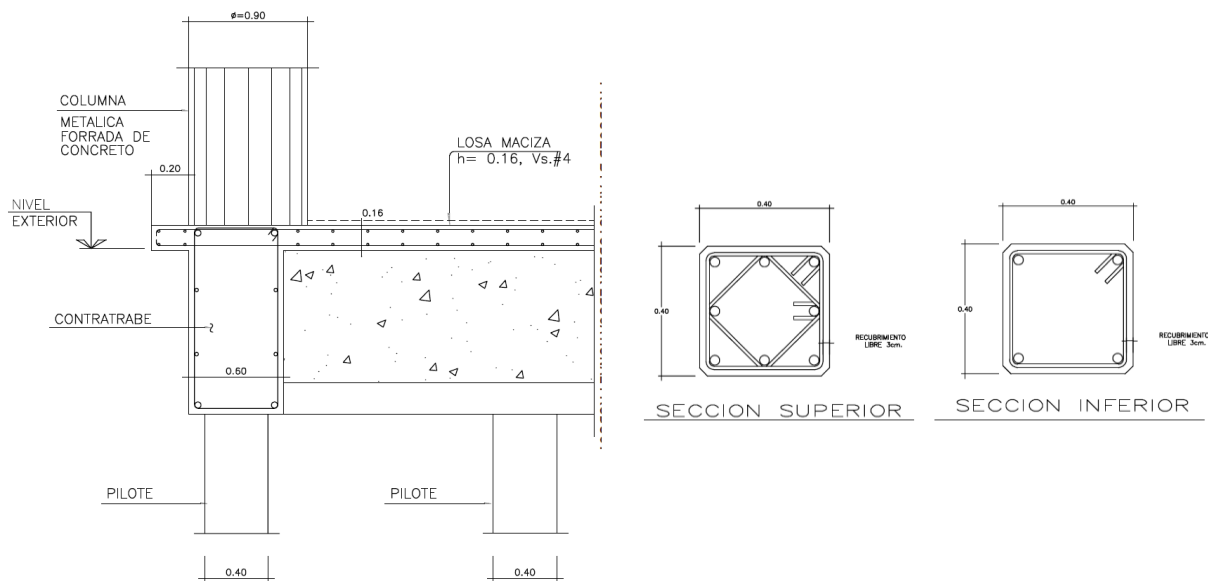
7 Corte esquemático de cimentación Dedo Norte y Sur, y sección de pilotes (ASA, 2005(c))
